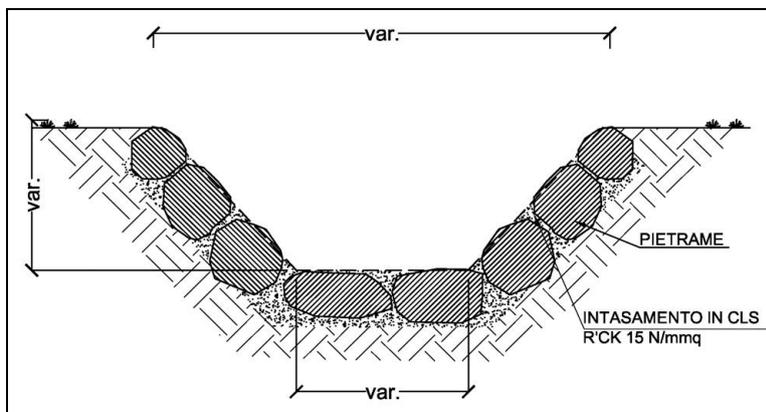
Sistema compluvio sud – Sezione in massi cementati
